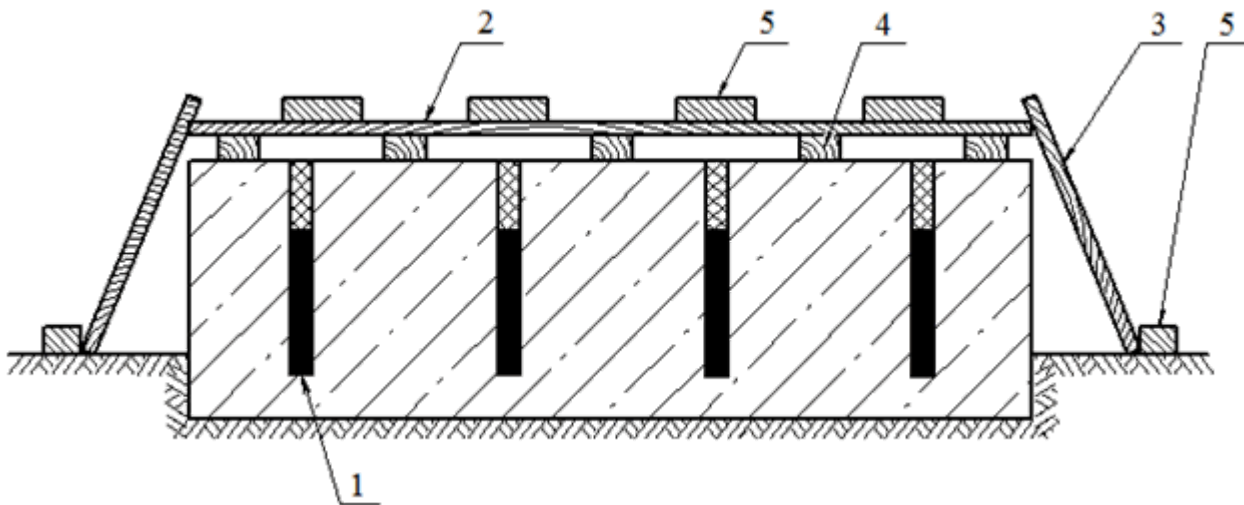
Установка суцільного щитового укриття на фундаменті:
